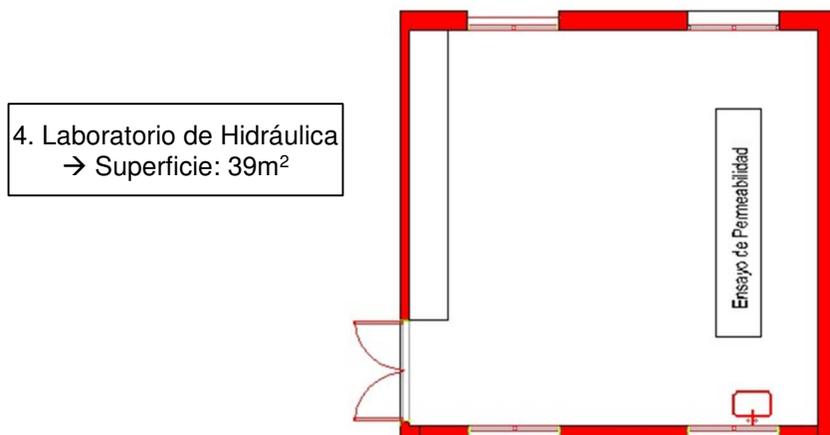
Planta y distribución de espacios del laboratorio de hidráulica.
